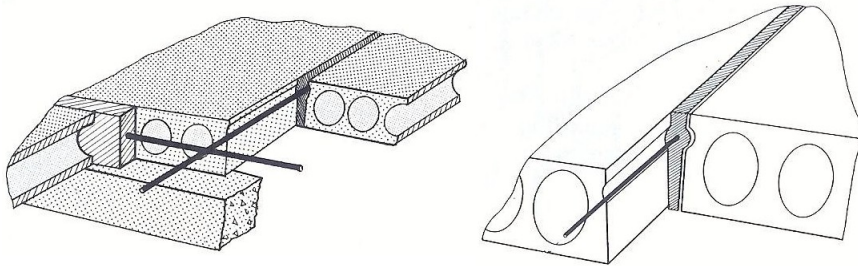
Ligação laje - laje com betonagem da junta longitudinal [6]
